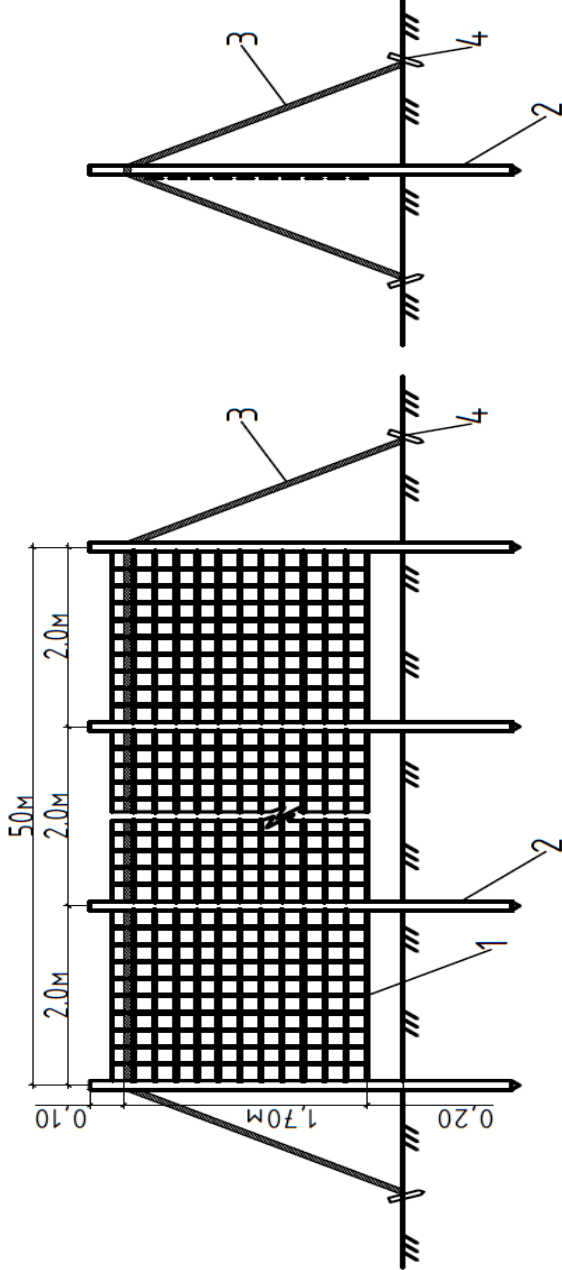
Схема установки снегозадерживающих устройств из полимерной сетки:
